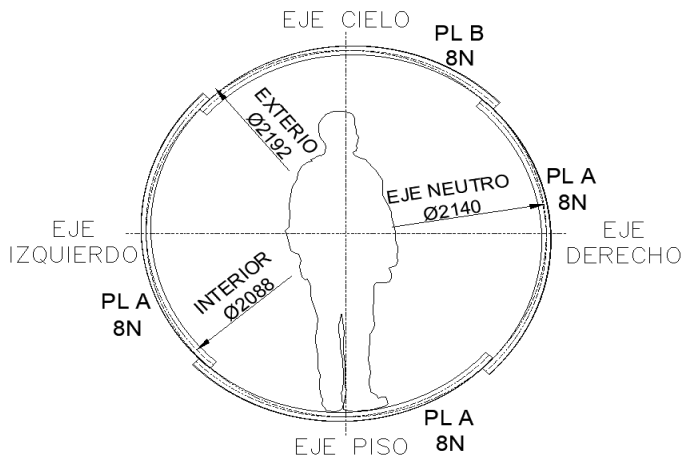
Tunnel liner D=2140mm, espesor de plancha e=3.0mm. Galvanizado
